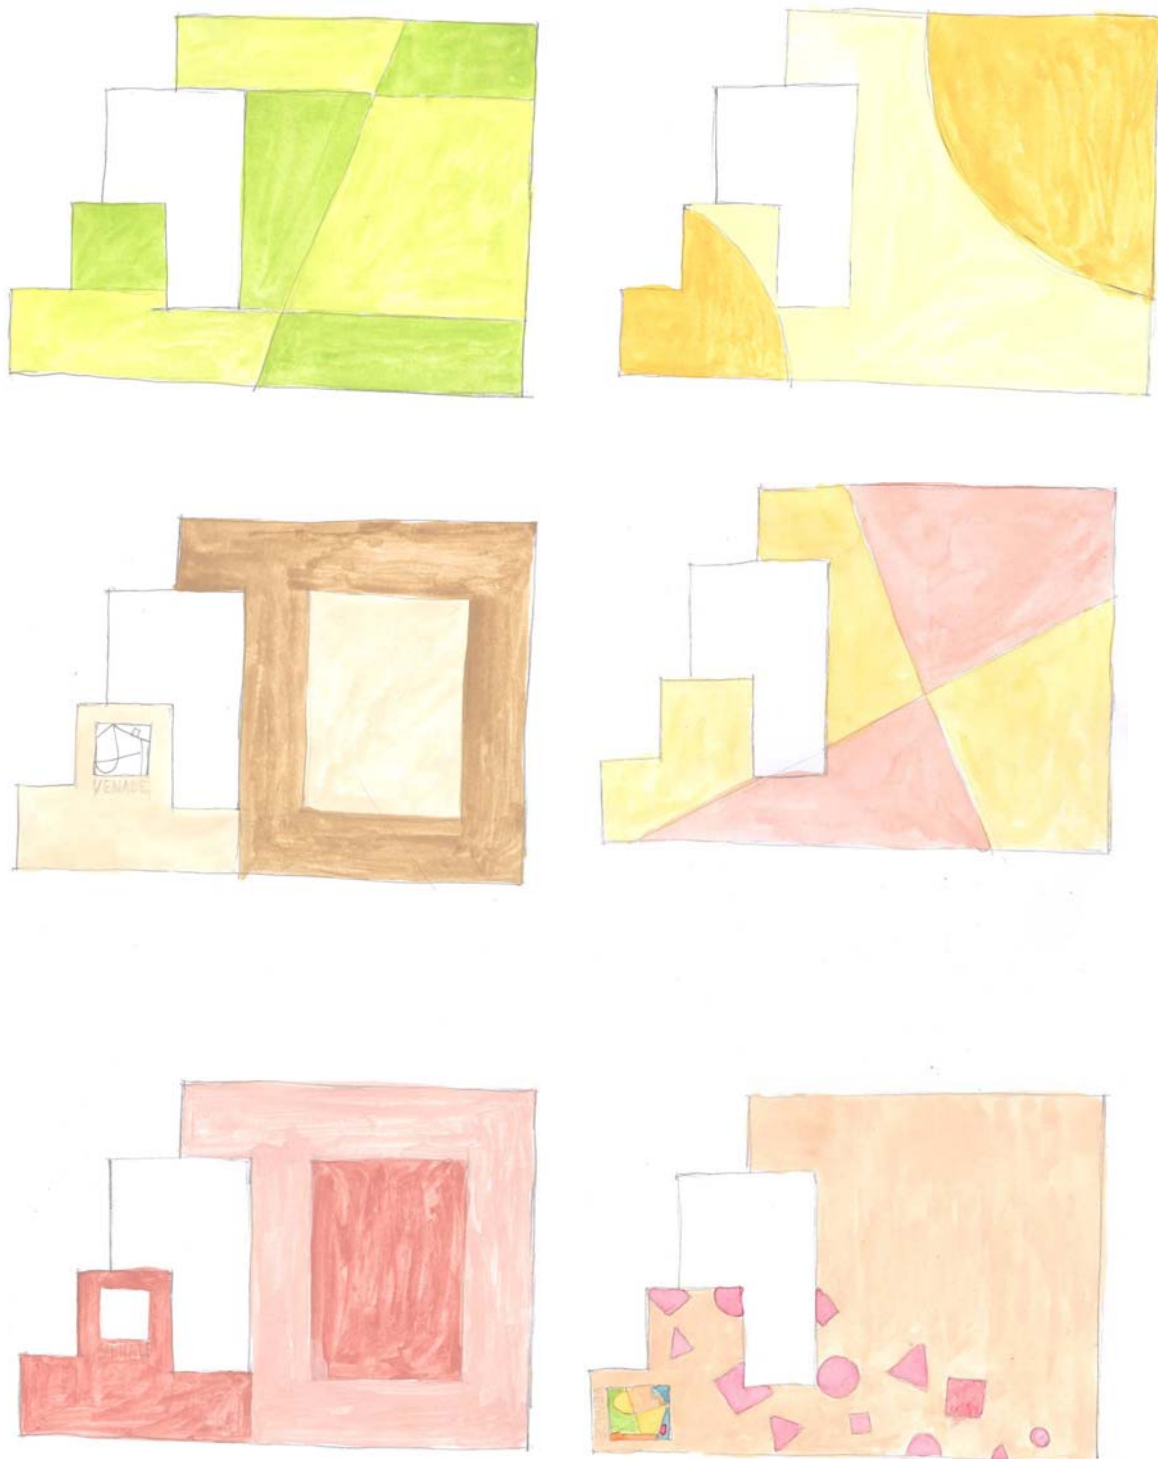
Estudos e esboços para aplicação de um pavimento em linóleo.
